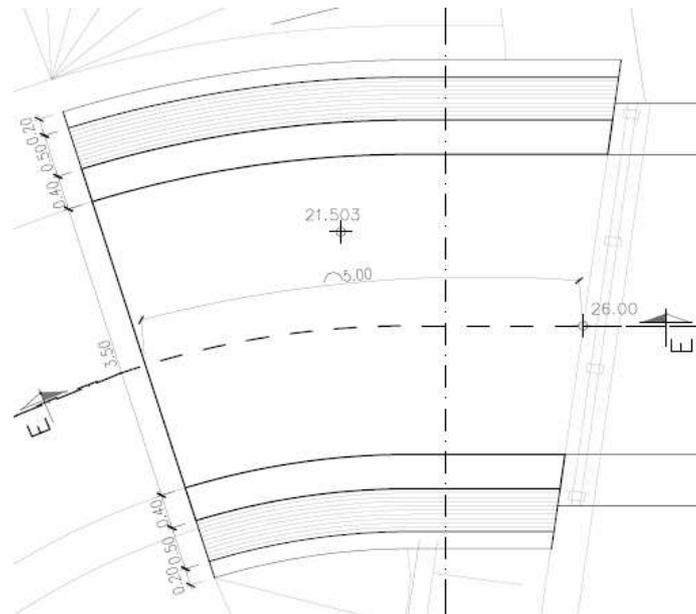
Muri di sbocco/imbocco lato Ovest - Pianta
